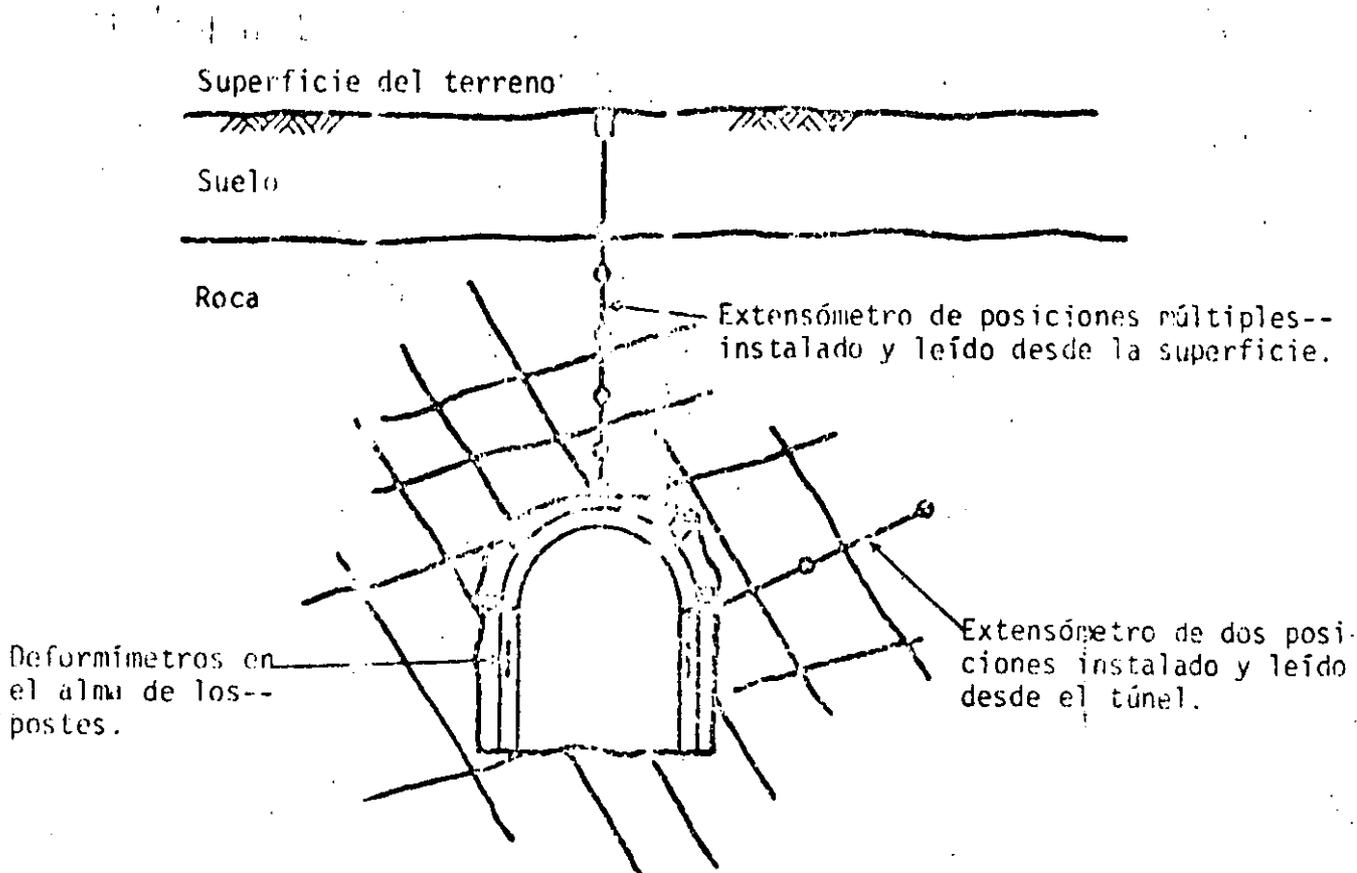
B Instrumentación de un túnel poco profundo en roca, con ademe de marcos metálicos.
